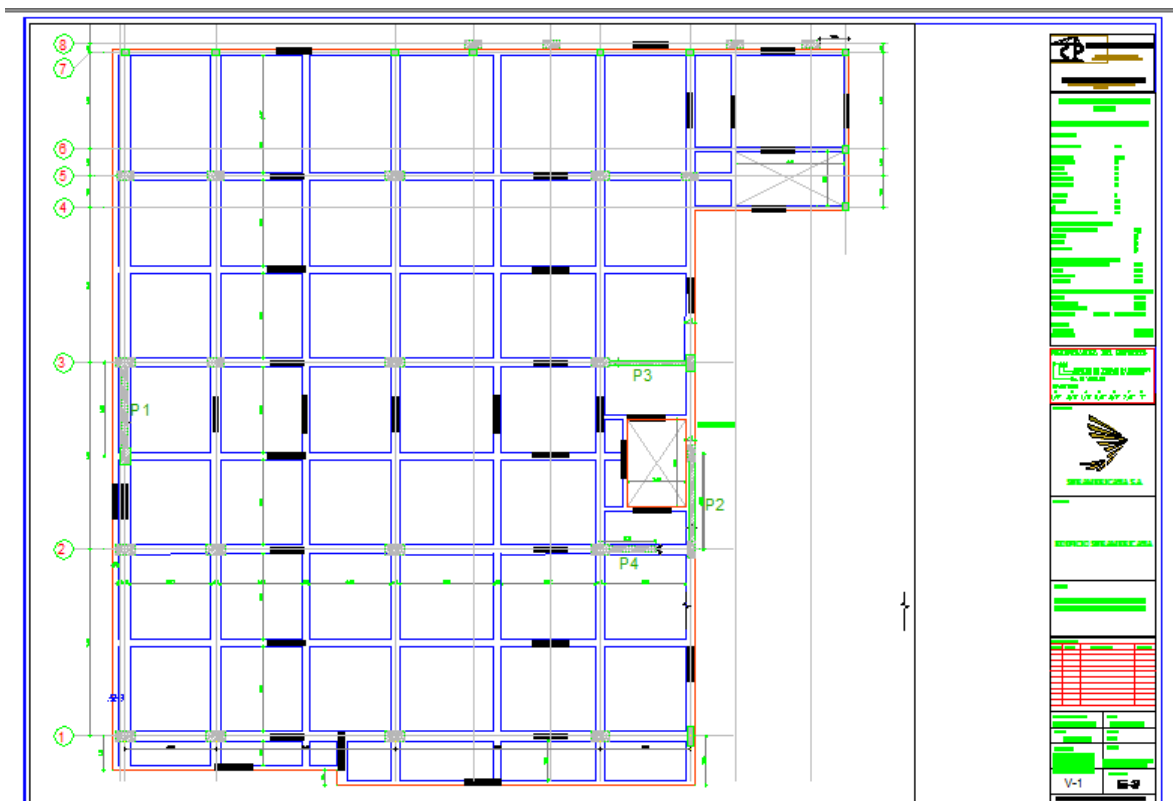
Plano correspondiente a la vista en planta del edificio Suramericana ubicado en la Carrera 51B N°
